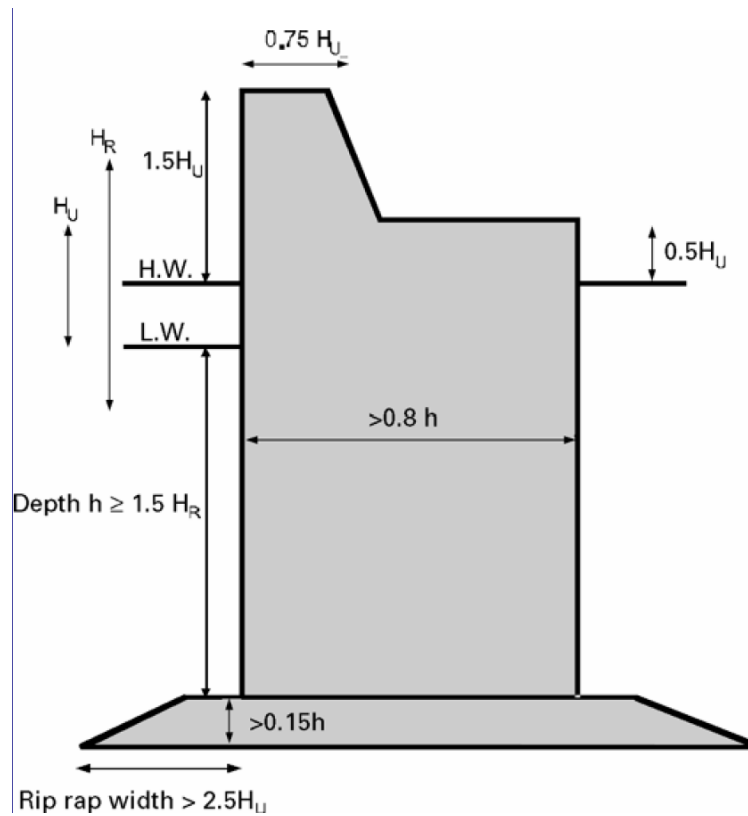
prédimensionnement d'une digue verticale (PIANC)
